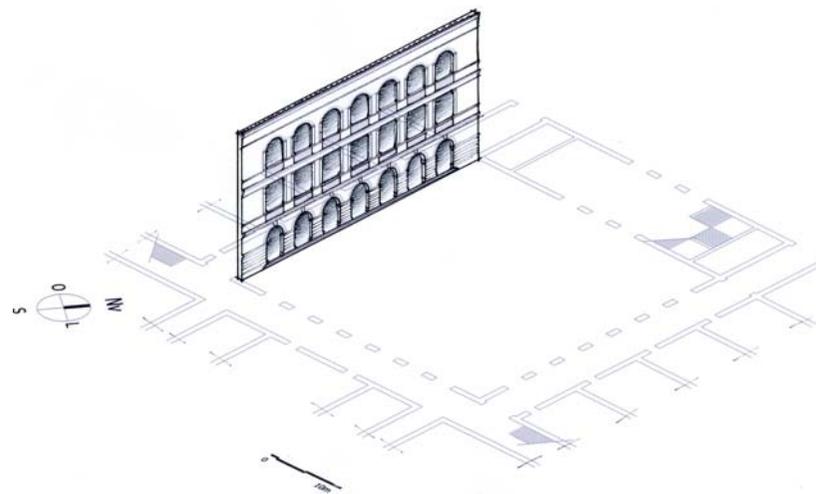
Estudo dos planos verticais, fachada Sudoeste do pátio interno do ISE RJ.
